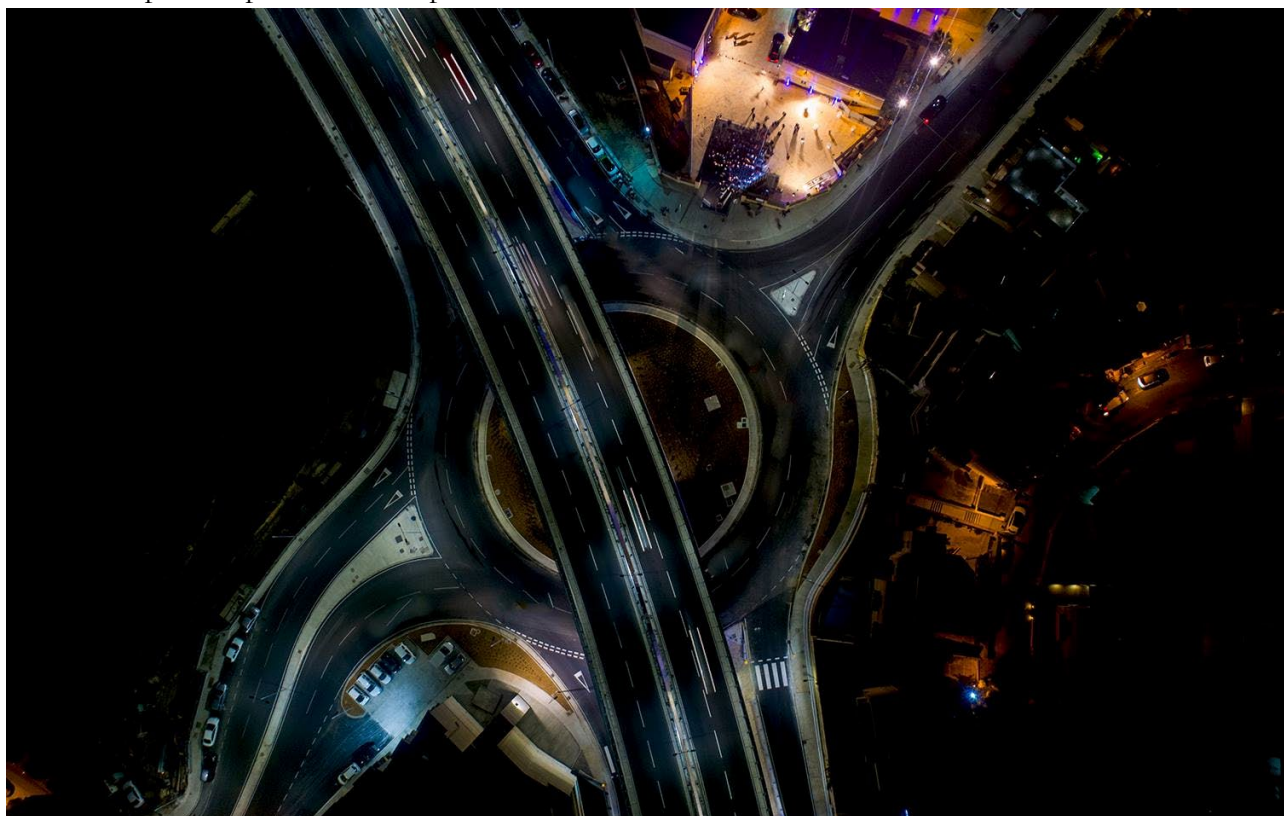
Vista aérea de la rotonda de Kappara con el paso elevado finalizado
